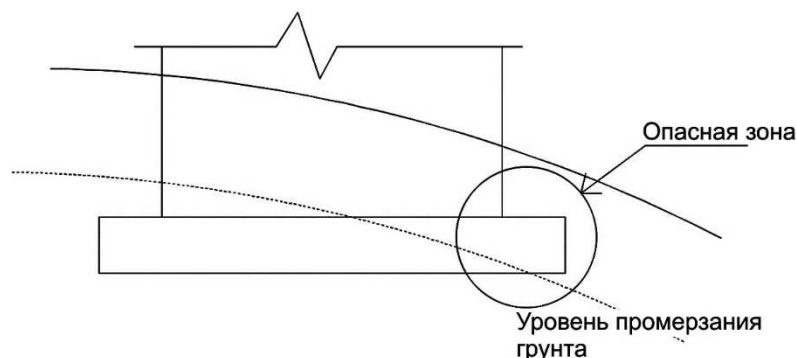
Мелкозаглубленный фундамент на склоне
